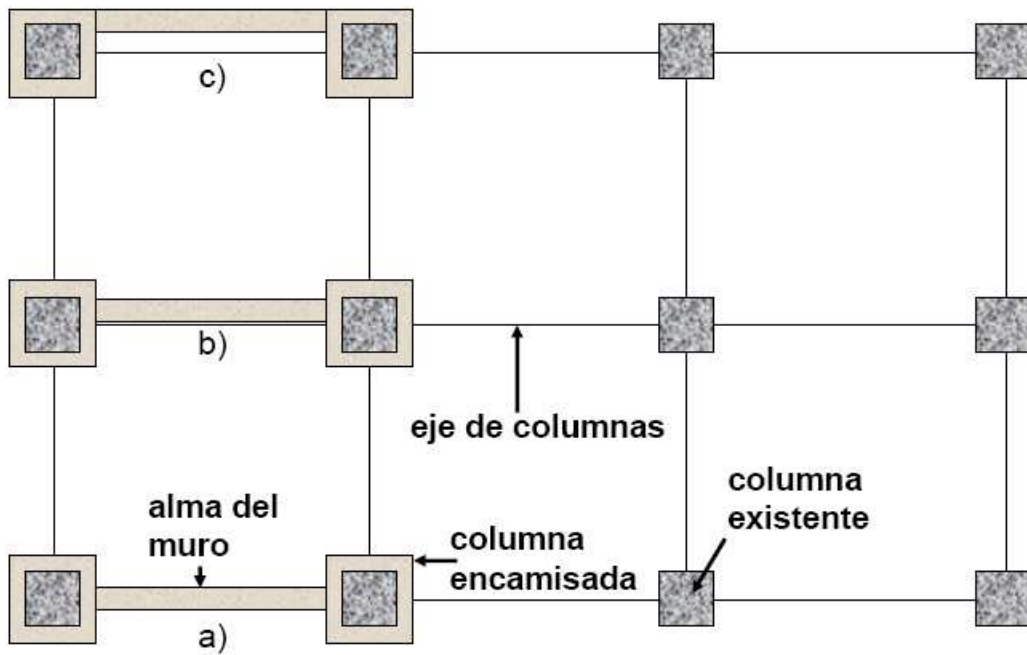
Solución con refuerzo de muros de concreto y encamisado de columnas.
